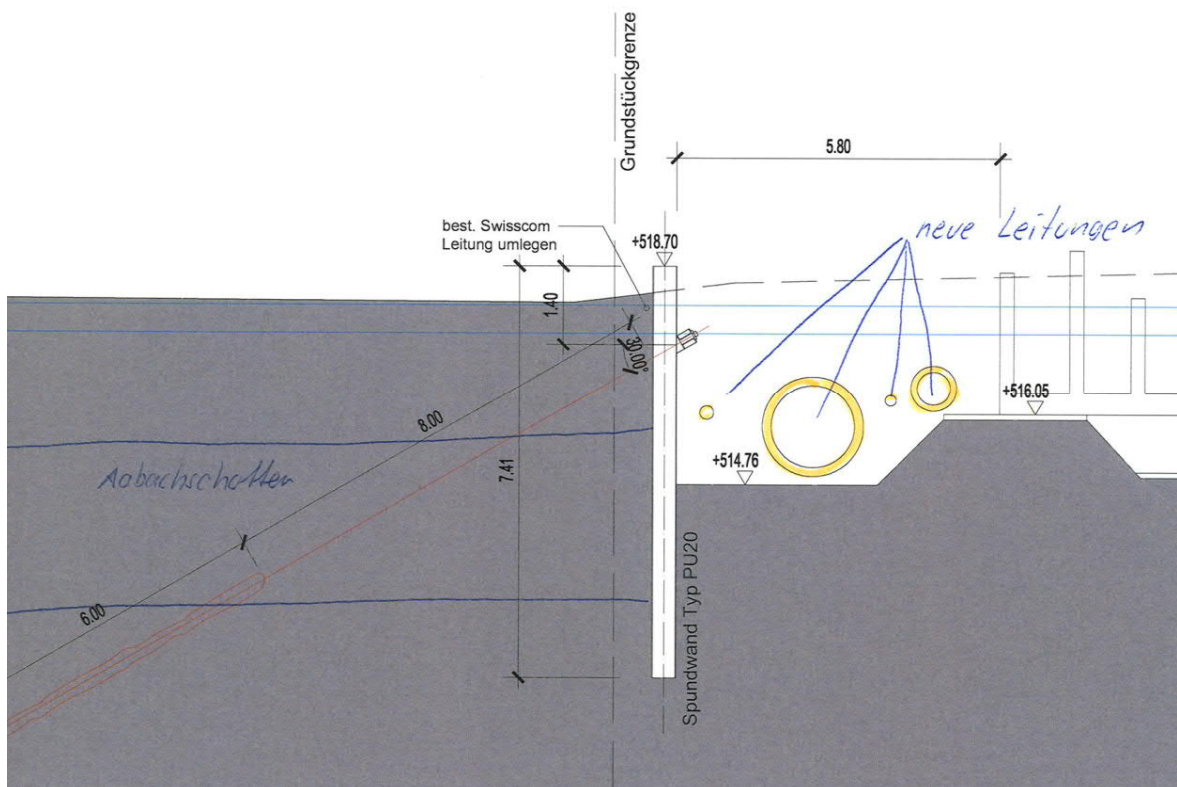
Baugrube Etappe 2b; Schnitt Baugrube
